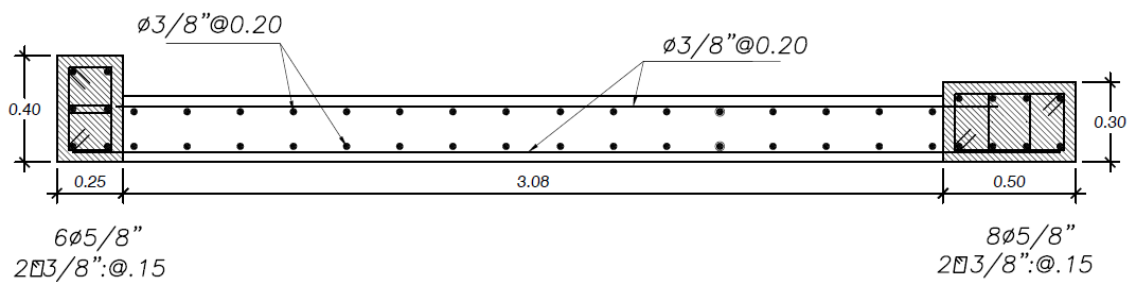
Detalle de refuerzo de la placa P-3
